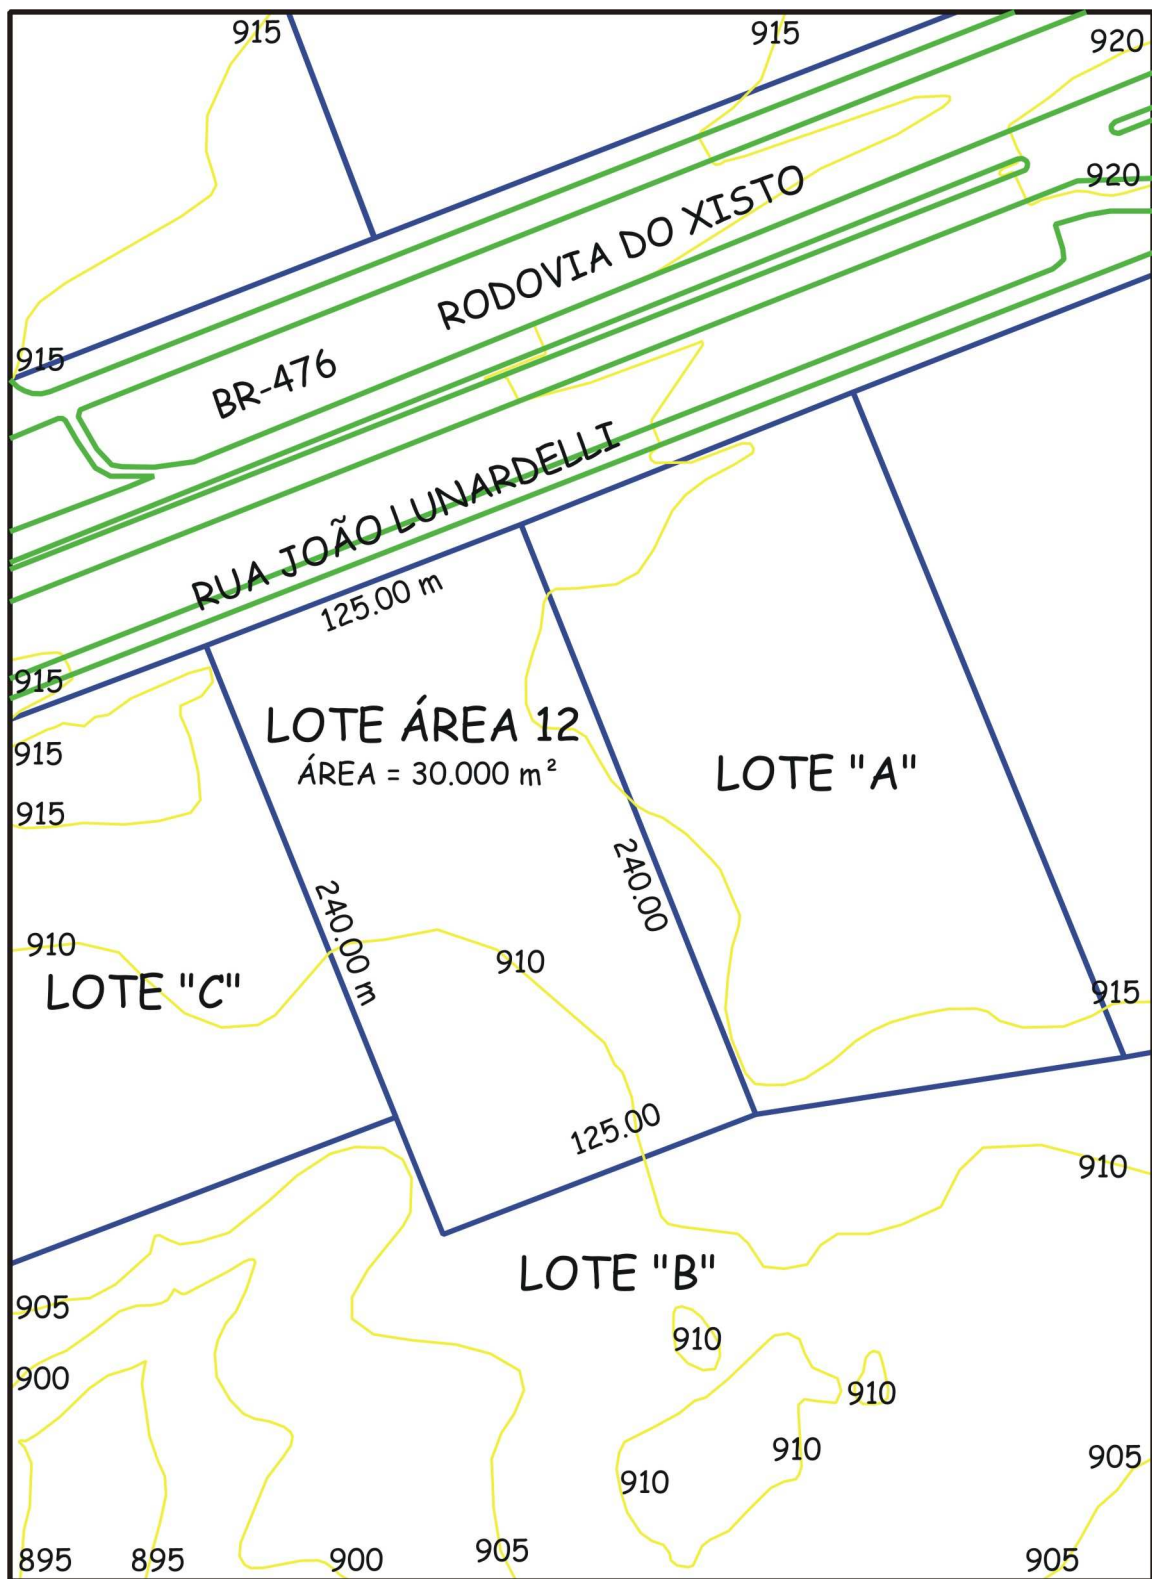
Planta Topográfica com o loteamento. (Fonte: Arquivo do Autor)
